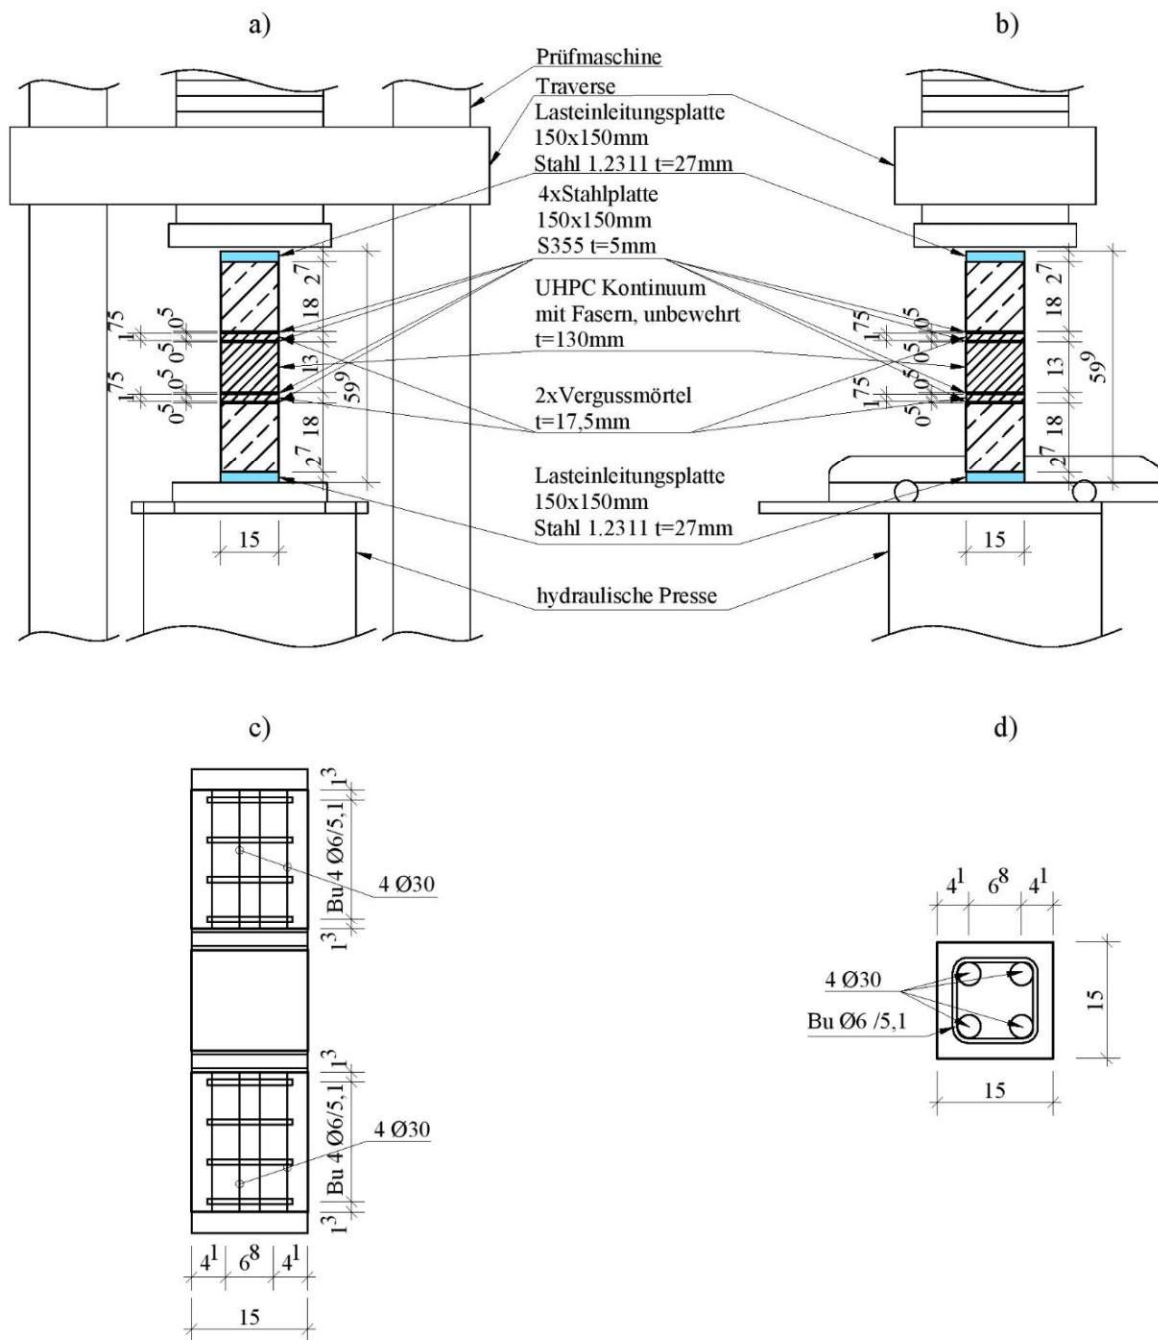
Stütze mit UHPC Kontinuum a) Ansicht von vorne, b) Seitenansicht, c) Bewehrung im Aufriss, d) Bewehrung im Grundriss
